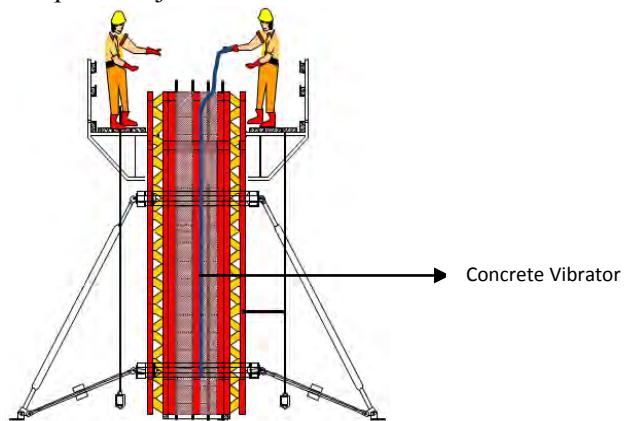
14 Layout Pengecoran Kolom Lantai 2
